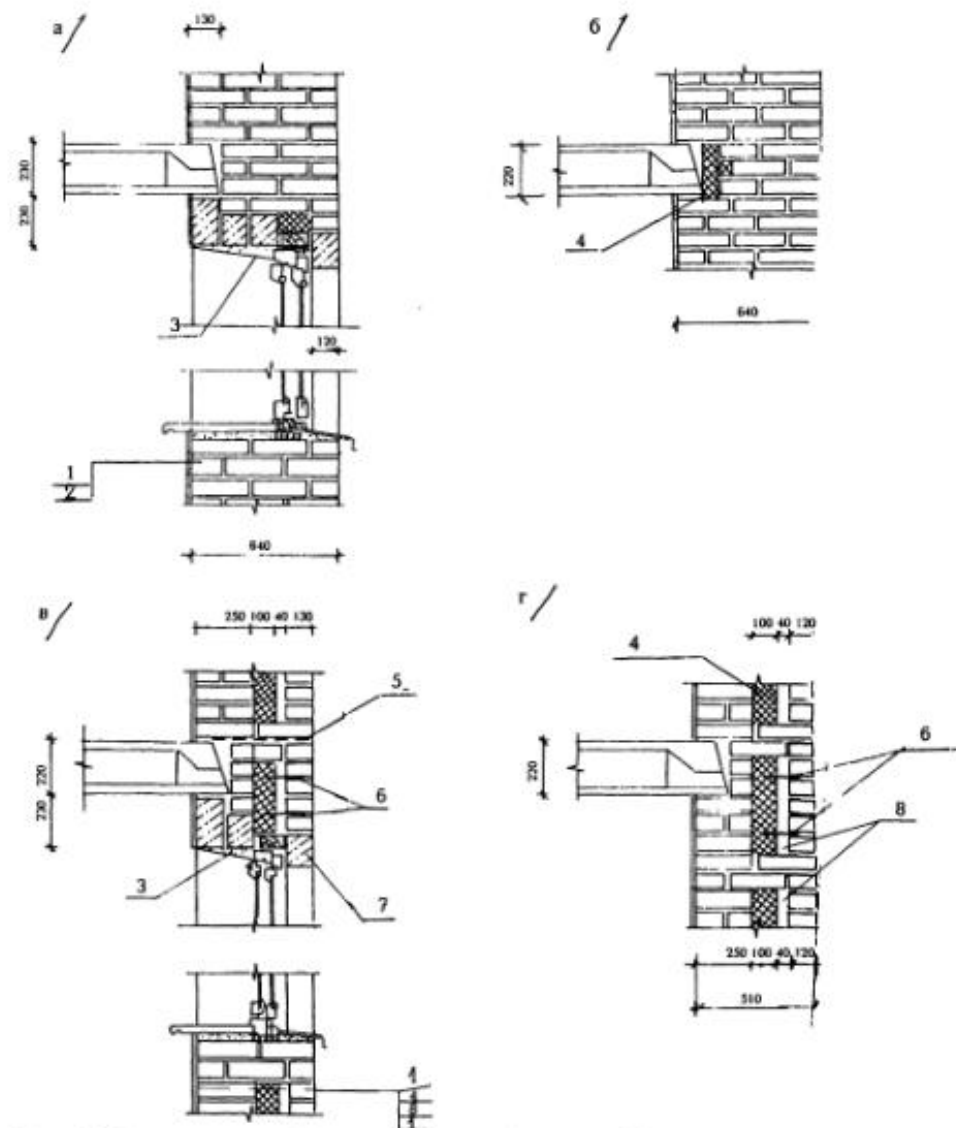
Детали сечений стен кирпичной кладки: (а) по оконному проему и по телу стены (б) при сплошной кирпичной кладке; по оконному проему (в) и по телу стены (г) при эффективной кладке; 1 - кирпичная стена; 2 - штукатурка; 3 - штукатурный откос; 4 - утеплитель; 5 - металлическая сетка; 6 - фиксатор утеплителя; 7 - железобетонная перемычка; 8 - воздушная полость
